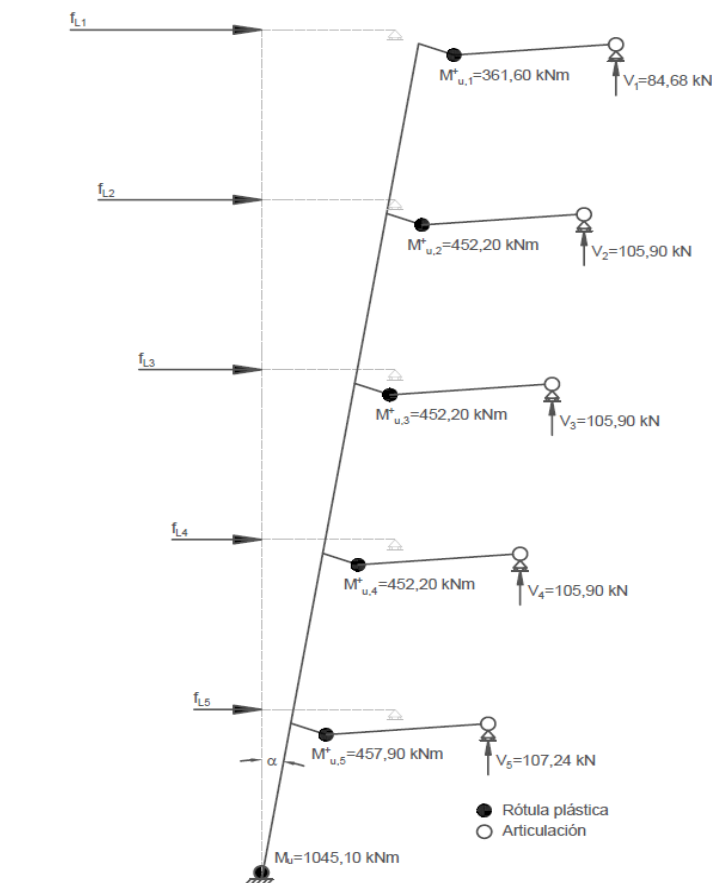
Análisis plástico del pórtico en el soporte equivalente al pilar 53
